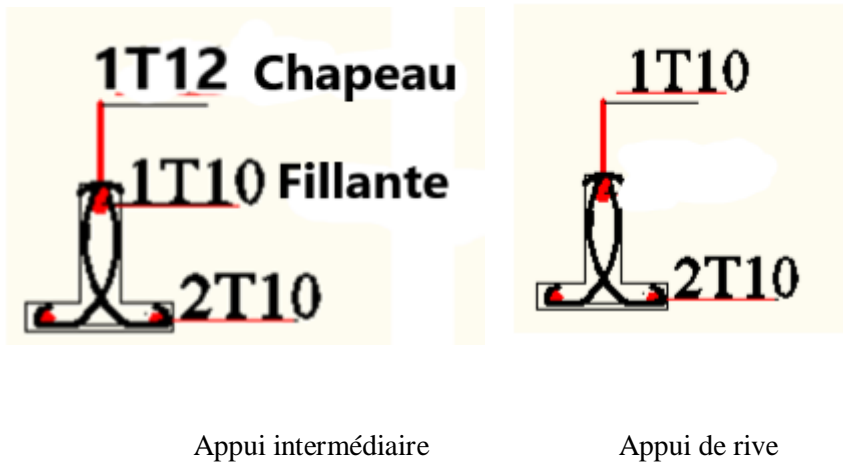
Dessin de ferrailage des poutrelles Etage courant et RDC (16+4).
